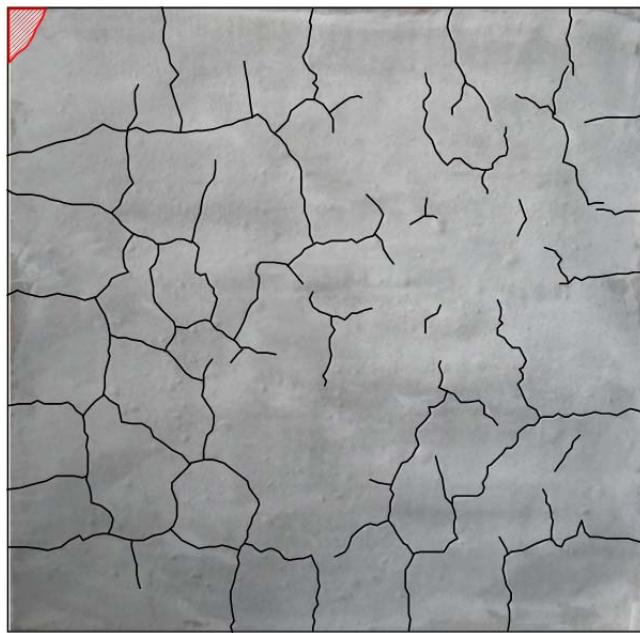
No. 8 浮き・ひび割れ発生状況[E3-C]
